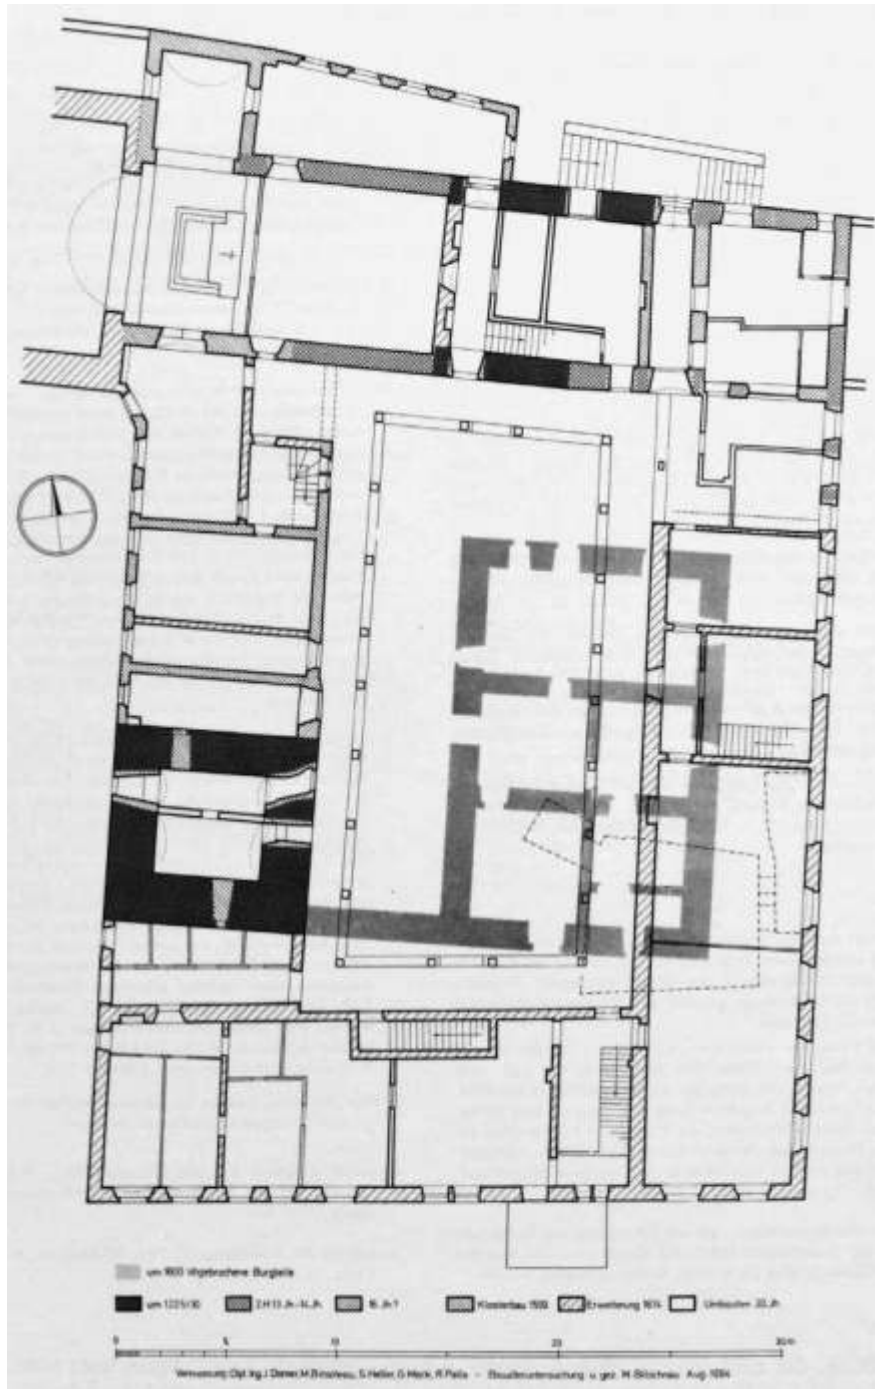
Bozen, Wendelstein/Kapuzinerkloster, Grundriss Erdgeschoss mit Baualtersplan nach RASMO/HÖRMANN-WEINGARTNER 1989, S. 106
